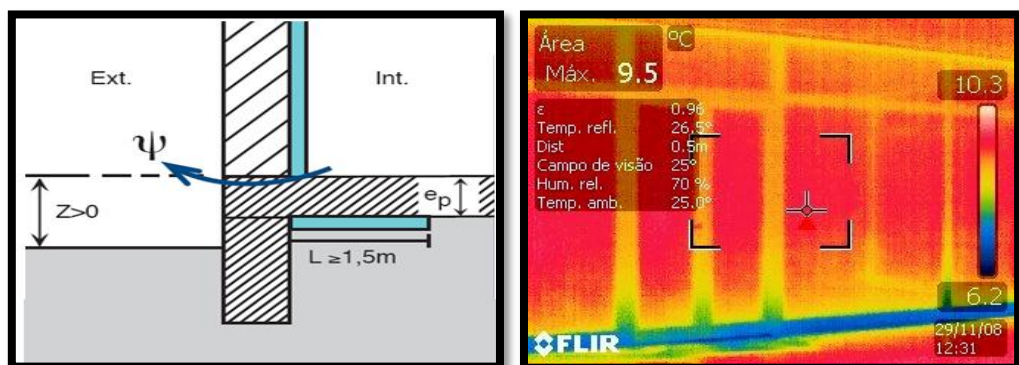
Ligação da Fachada com Pavimentos Térreos; fonte: RCCTE (2006); Finn M. (2004)
